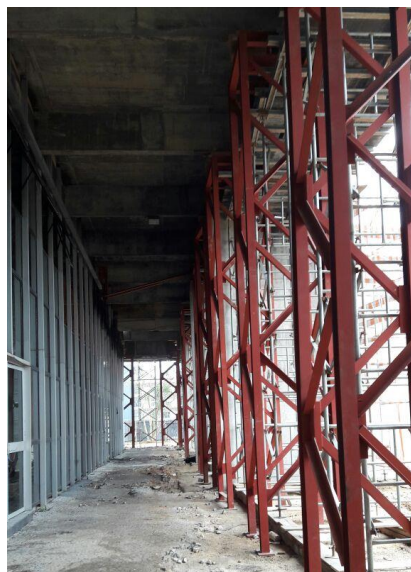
Estruturas metálicas de apoio. (Fonte: Dos autores 2016)
